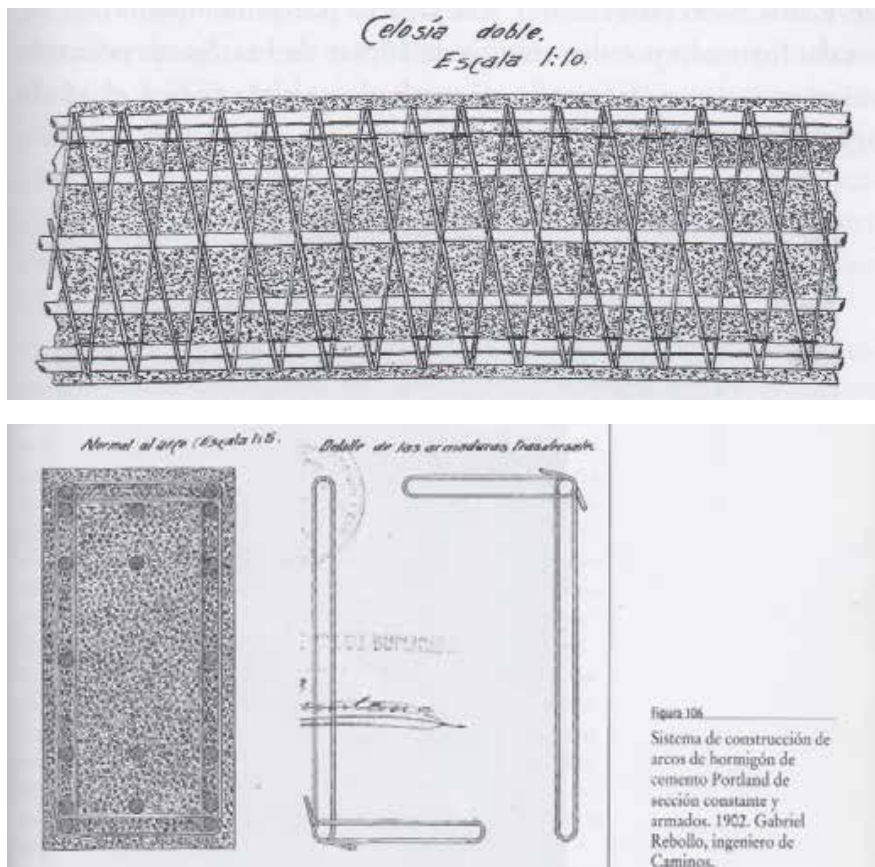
Planos de la armadura de las vigas de hormigón. Patente de G. Rebollo para las estructuras de sus puentes: celosía doble, normal al arco y transversal, de 1902. (Señaladas en el Libro de A. Burgos. Orígenes del HA. CEDEX)
